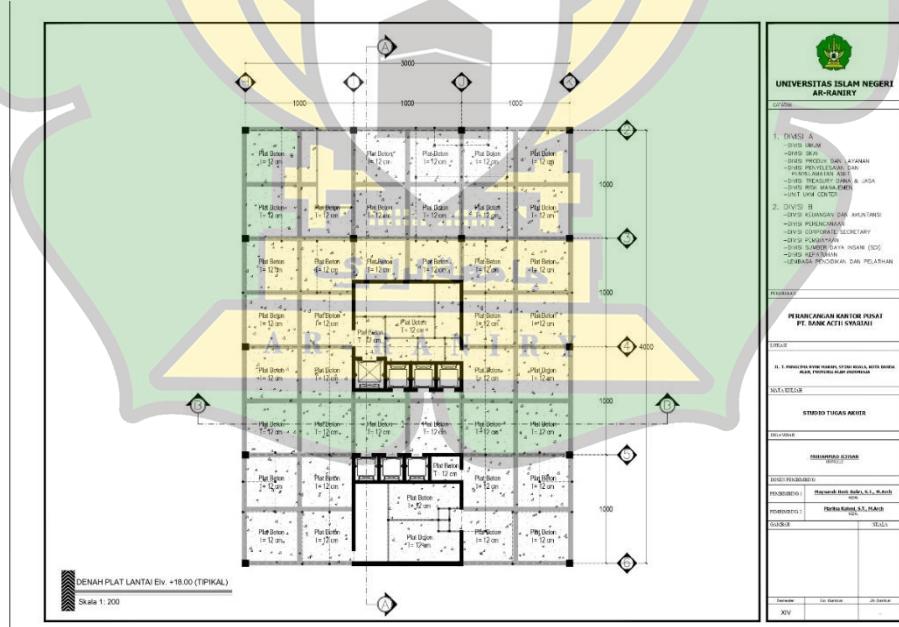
Denah Plat Lantai Elv. +10.00
